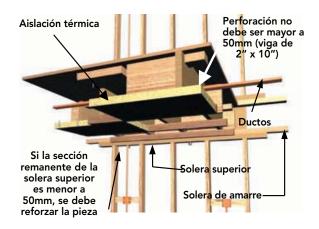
19: La perforación en soleras debe efectuarse en el eje central, con un diámetro no mayor de 1/3 del ancho de la pieza.
